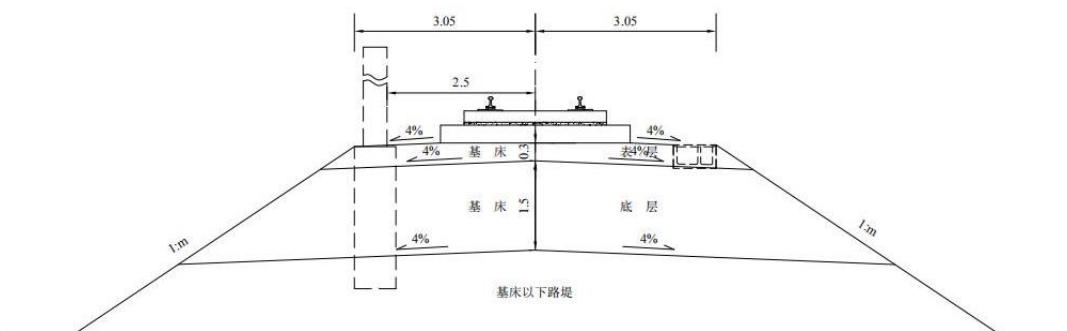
无砟轨道单线路堤横断面图 (单位: m)
